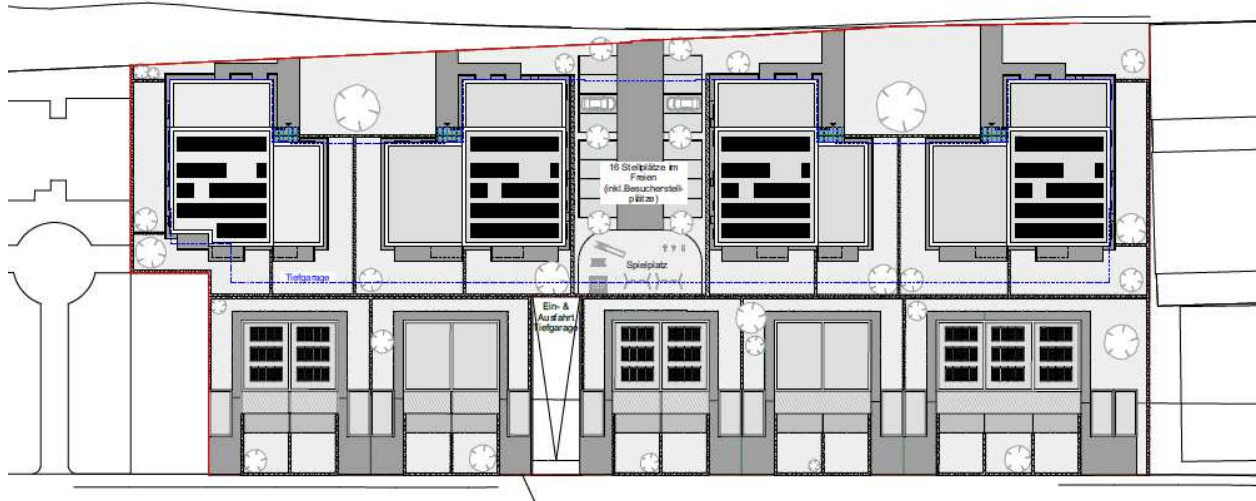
Städtebauliches Konzept, Lageplan; Bildquelle: WSW Baubetreuung GmbH, August 2021
